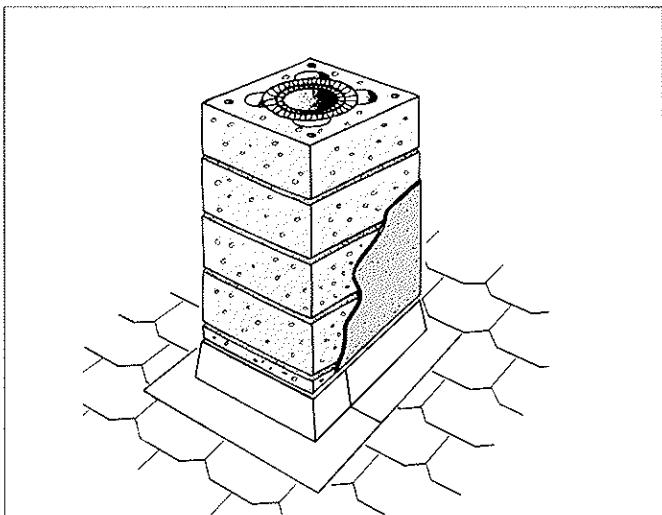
Pipebeslag tilpasset for flatt takbelegg (papp, shingel m.m.). Beslaget er teleskopisk, kan anvendes kun på pusset ettløps pipe.
